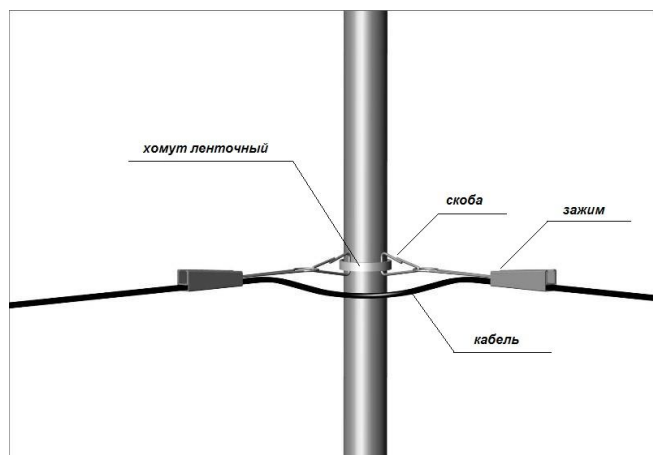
Схема крепления натяжных зажимов к опоре (вариант исполнения).
